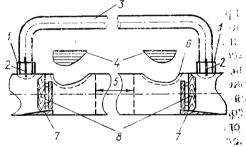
Схема устройства обводной трубы для ремонта участка куз газопровода под газом:
